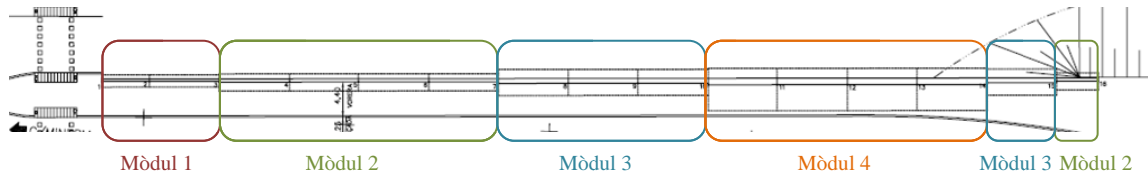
Plànol núm.18.1 full 2 Mur 1 planta.
